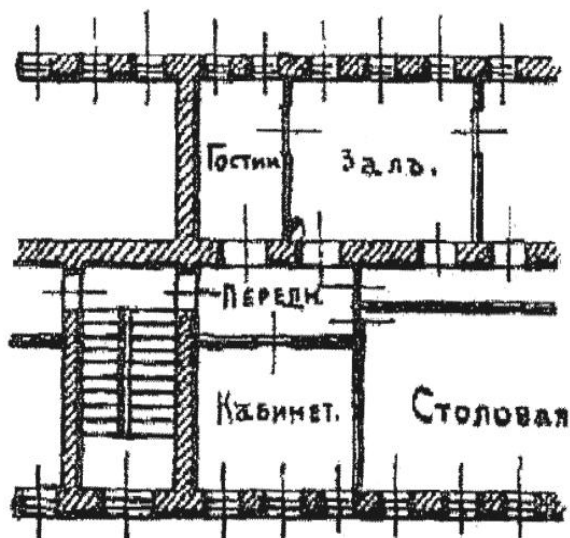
Расположение парадной лестнице посередине фасада с примыканием к капитальной стене
